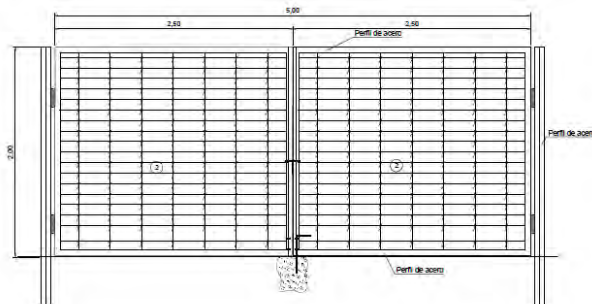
Detalle puerta de acceso a Planta Fotovoltaica
